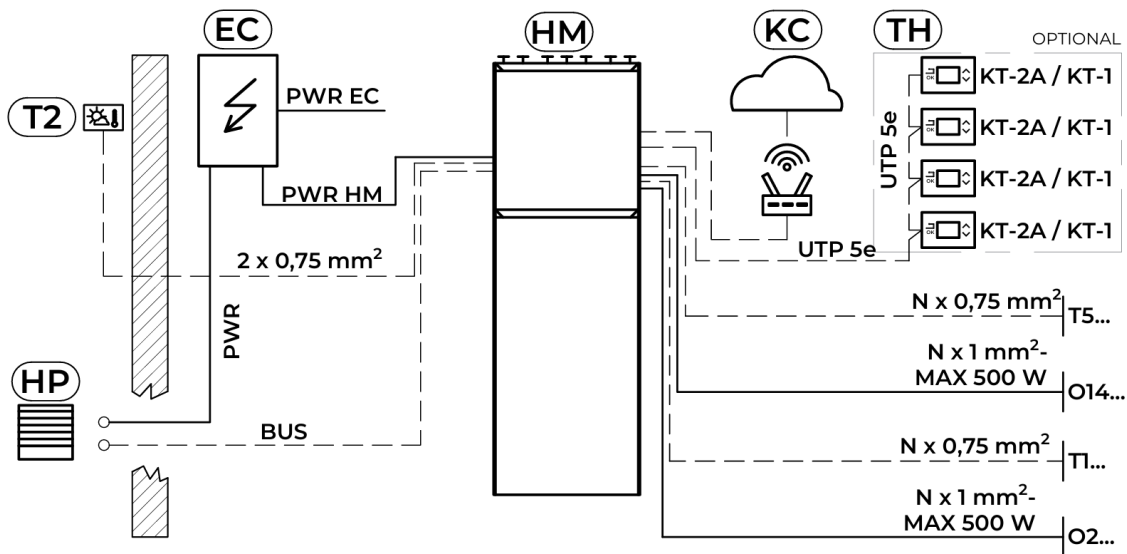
Elektrisches Anschlussschema HYDRO C2
